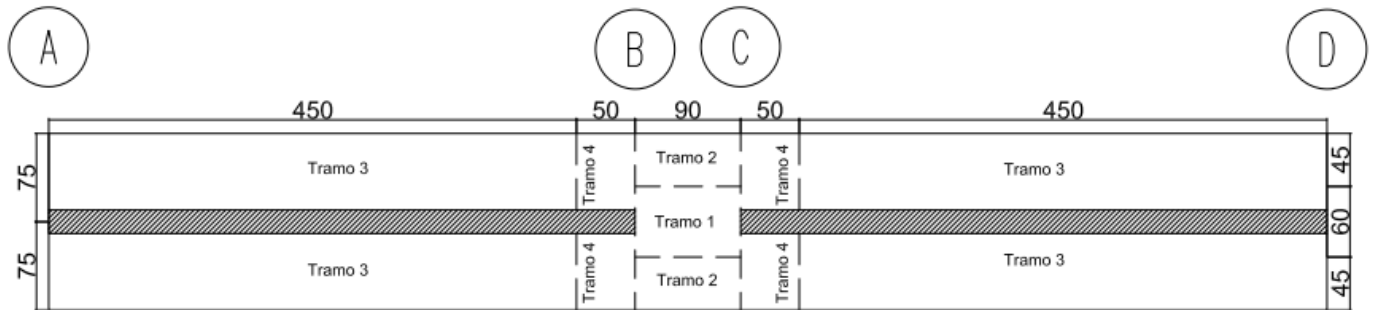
Plano de losa – Sistema de Muros Rectos (Modificado de Henríquez, C. 2019)
